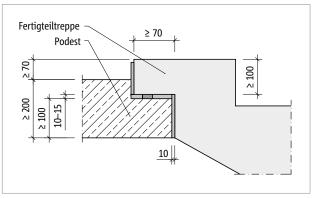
Schöck Tronsole® Typ BZ: Ausführungsvariante Auflagerung eines Elementtreppenlaufs am Podestrand mit Konsolausbildung
